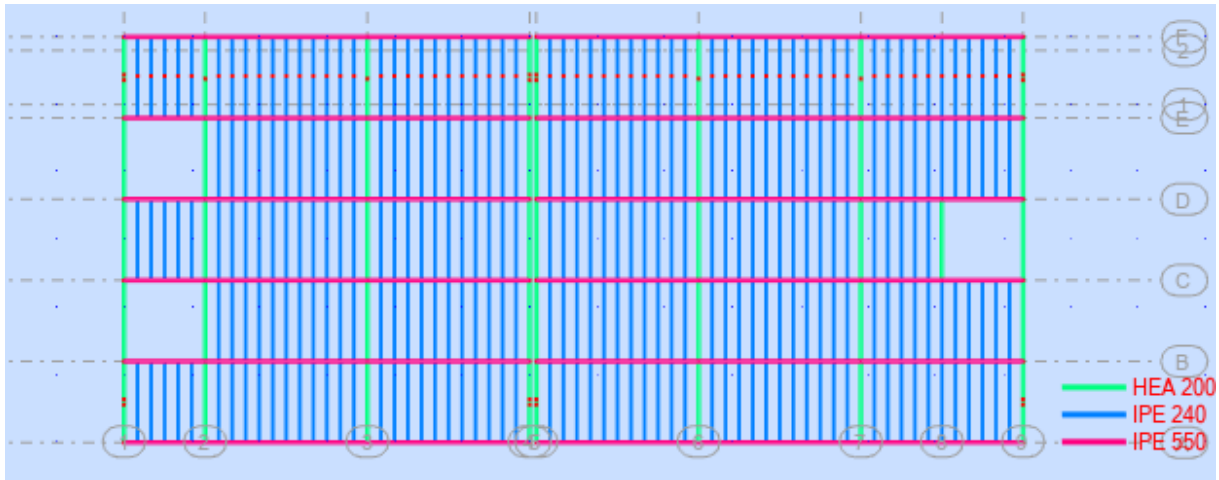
Vue en plan du plancher niveau : 8.84 m
